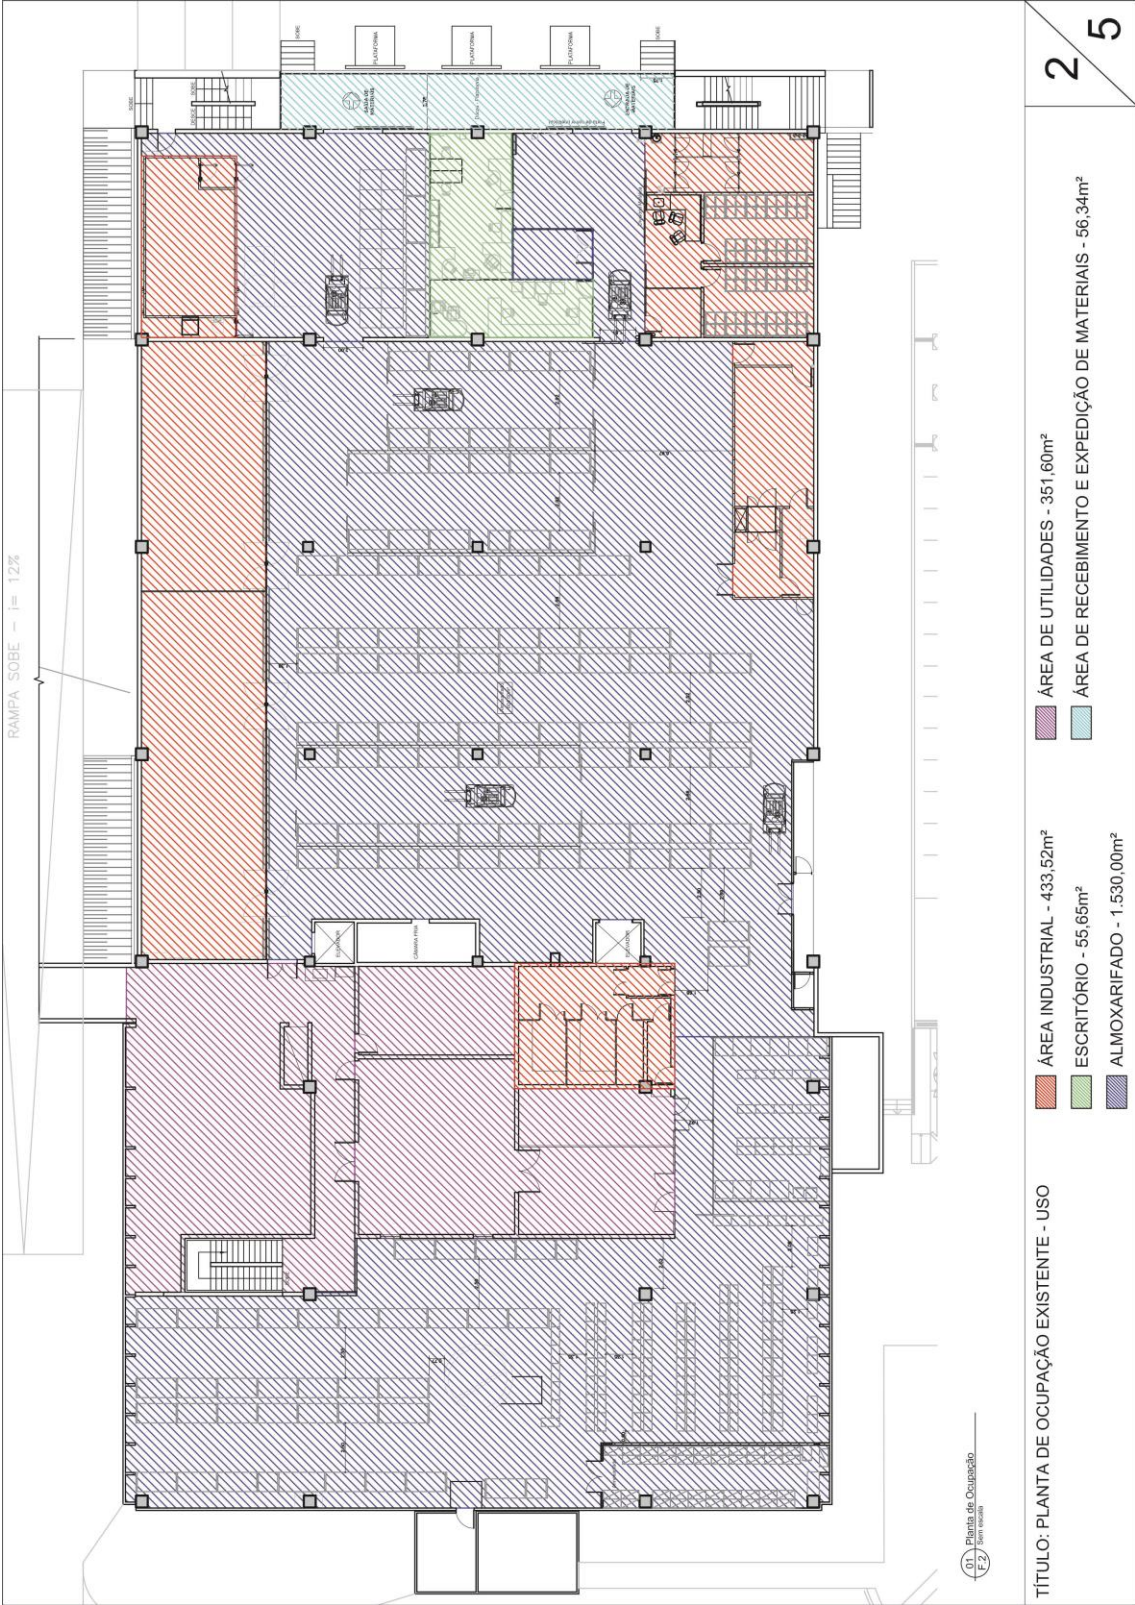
Planta de ocupação existente - uso, São Paulo - SP.
